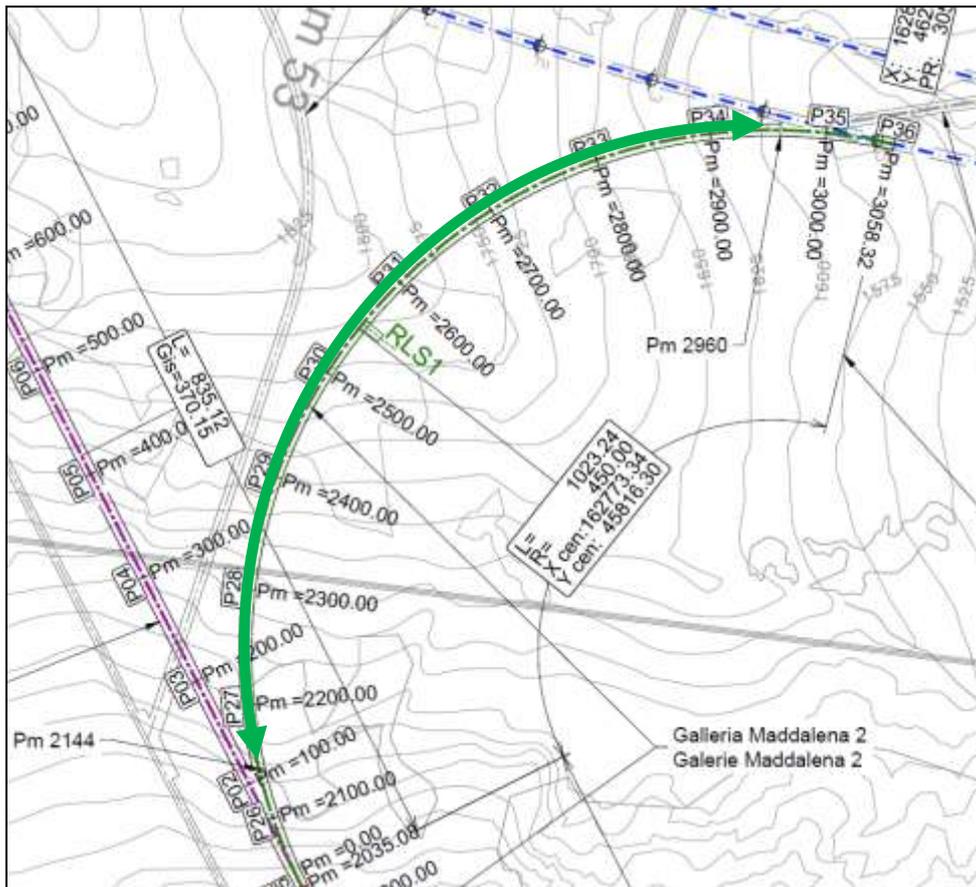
Planimetria delle zone di stoccaggio in Maddalena 2 (PRV_C3A_7520_26-48-11)
